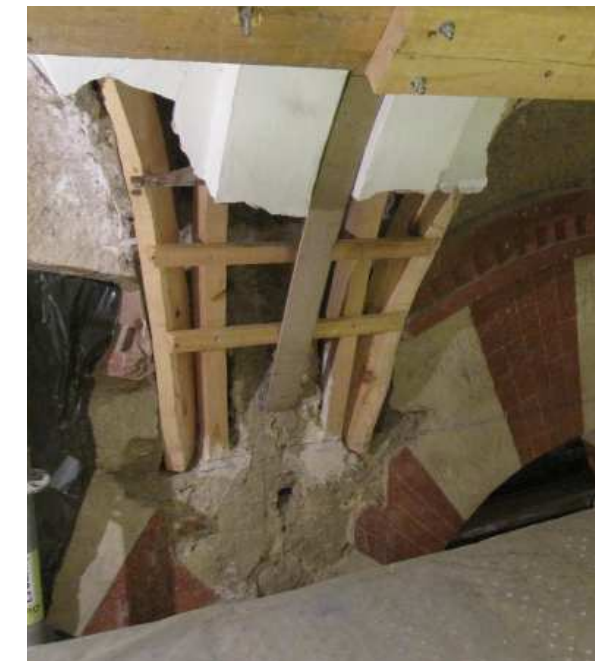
Reparación de los camones en su apoyo en el muro.
